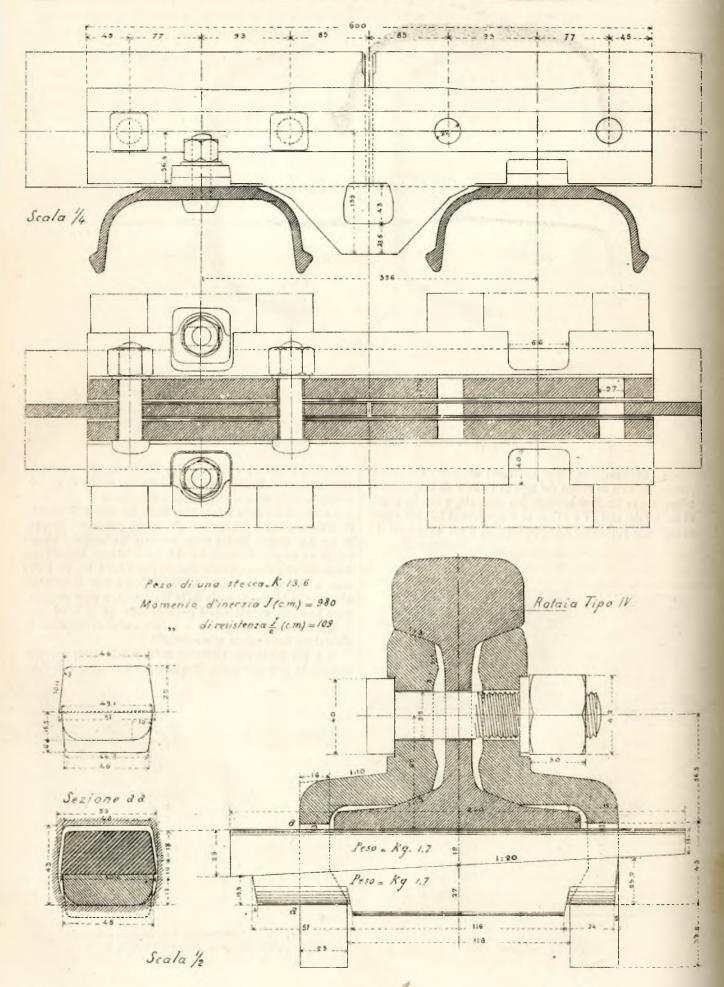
, 74, 75, 76 e 77. — Stecca a chiavetta per la giunzione delle rotaie tipo IV su armamento metallico.
